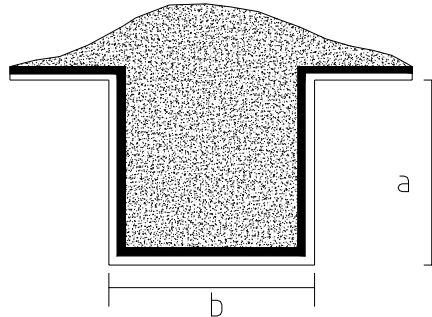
Detalhe da trincheira drenante (SERAPHIM, 1996)
